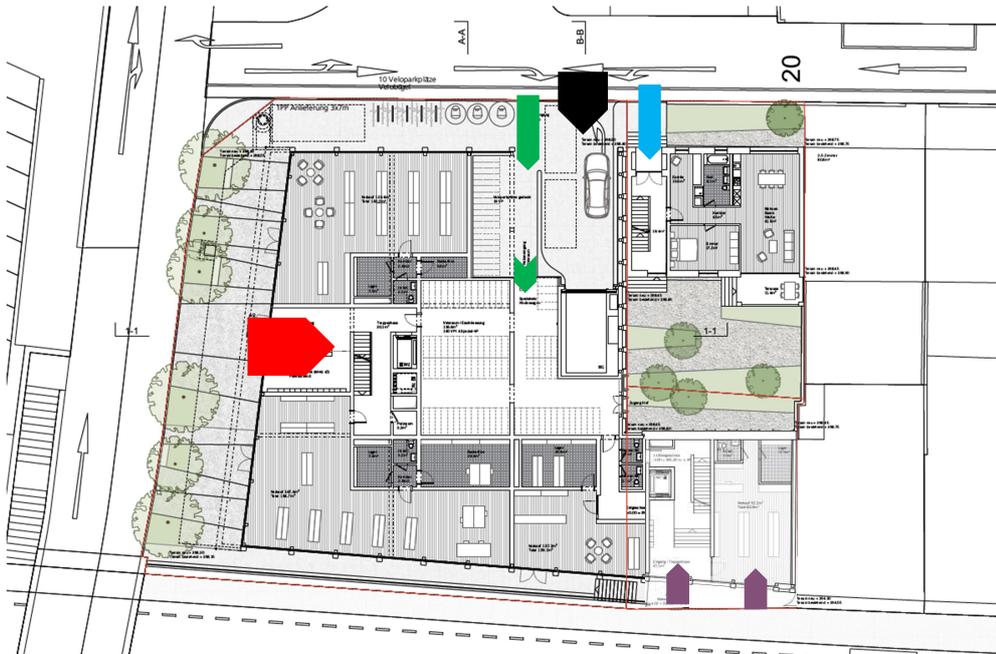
Erdgeschoss Tannwaldstrasse/Unterführungsstrasse (Kombination der Grundrisse)
